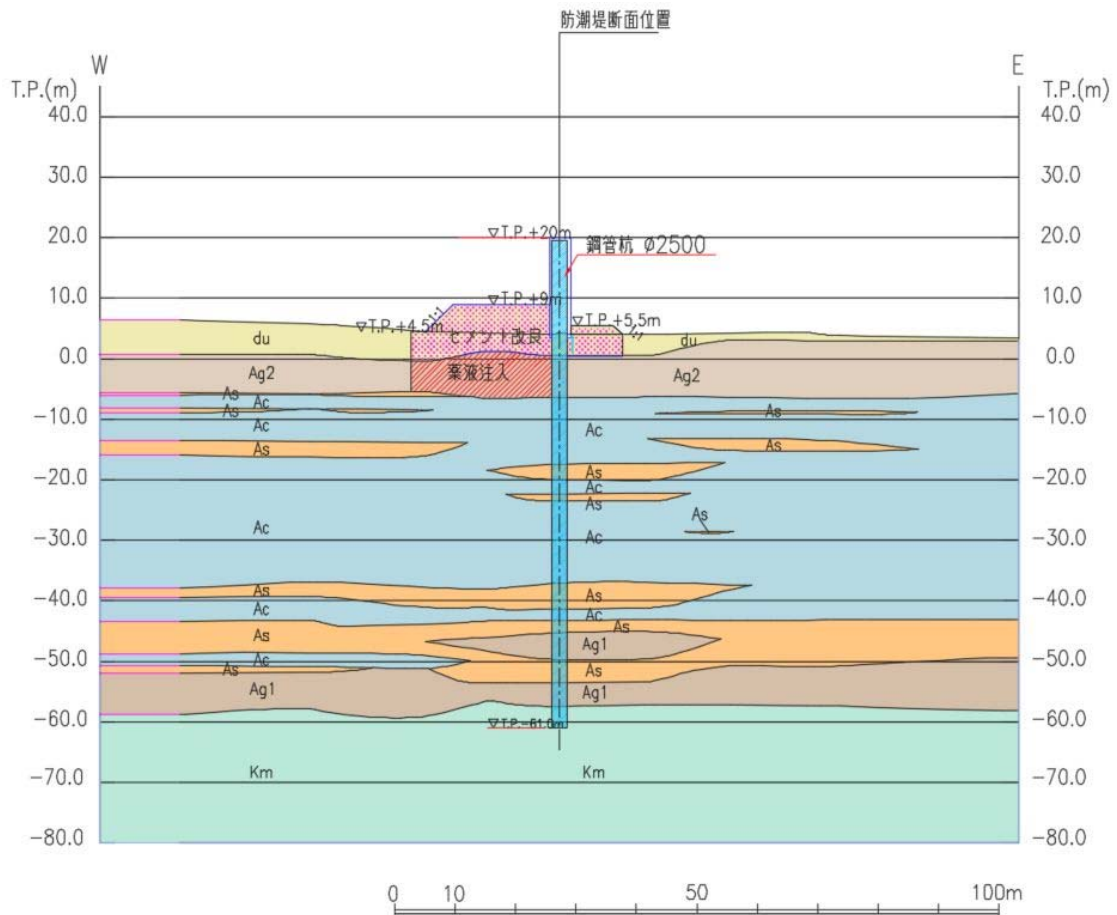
11. 5—21 (3) 鋼管杭鉄筋コンクリート防潮壁 断面図 (断面③)
